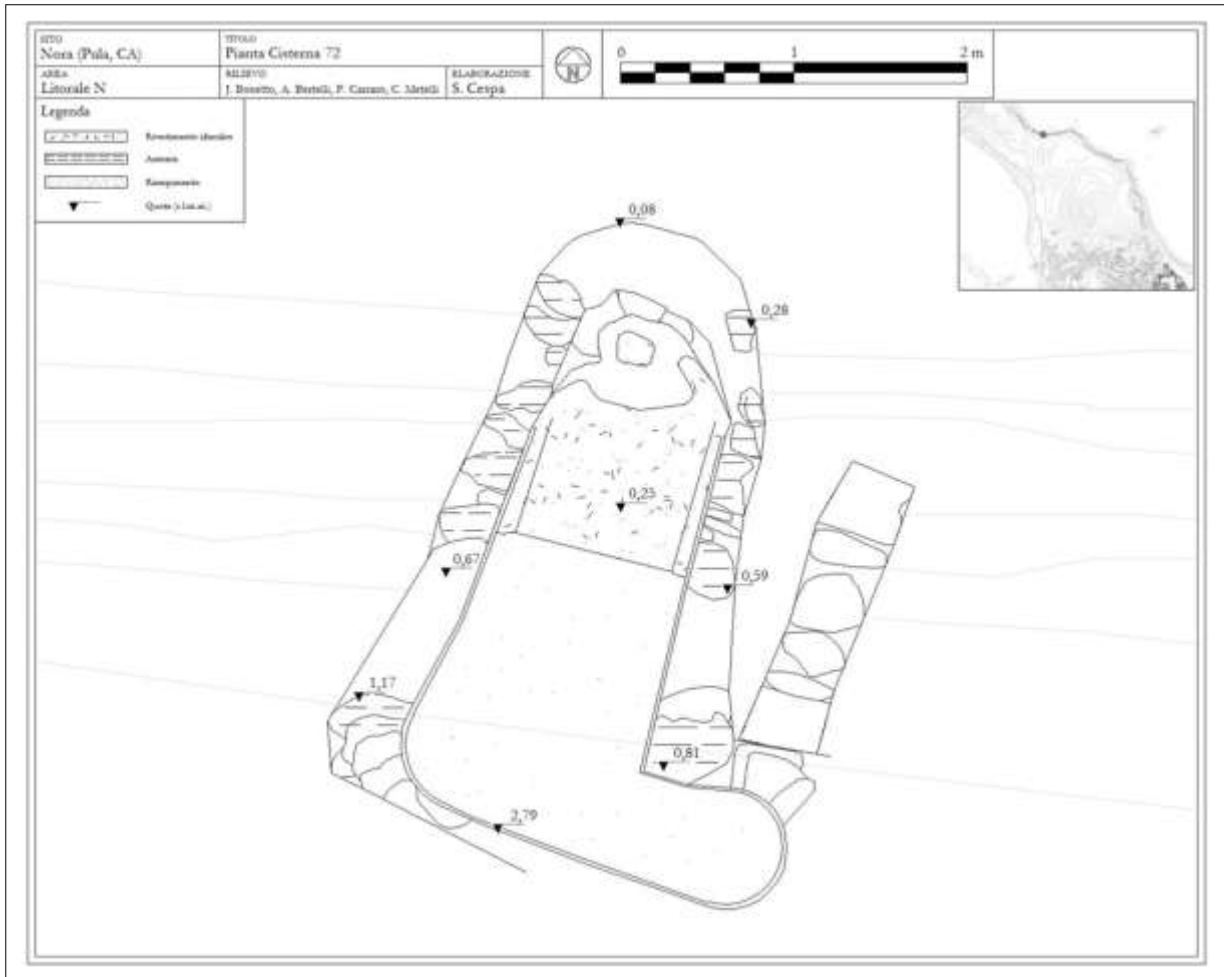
Pianta della cisterna 72 (elaborazione dell'autore).
